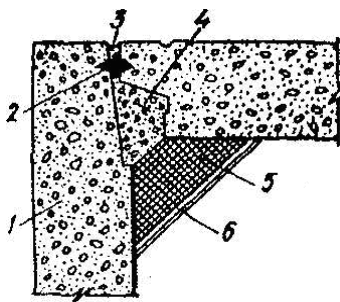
Утеплення кутового стику панелей: 1 – стінова панель; 2 – жмут; 3 – цементний розчин; 4 – теплий бетон; 5 – ефективний утеплювач; 6 – опоряджувальний шар
